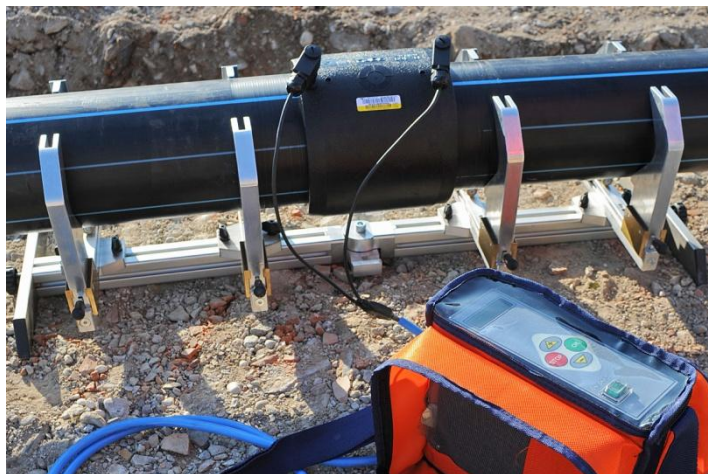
Eletrossoldadura de tubos de PEAD por meio de união eletrosoldável (<http://polyweldmachinery.com.au>).
